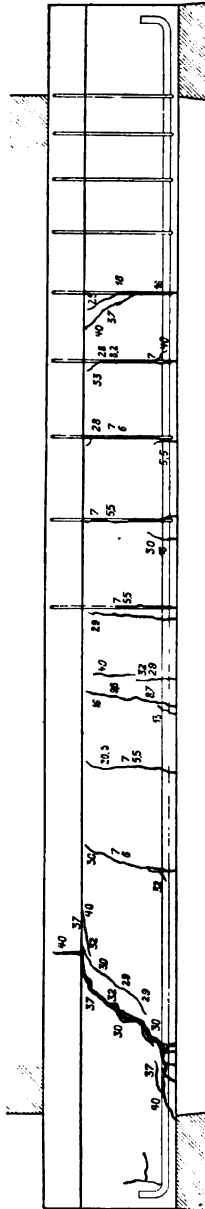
Balken II, 3 ø 18 mm, Bruchlast 40,0 t.
